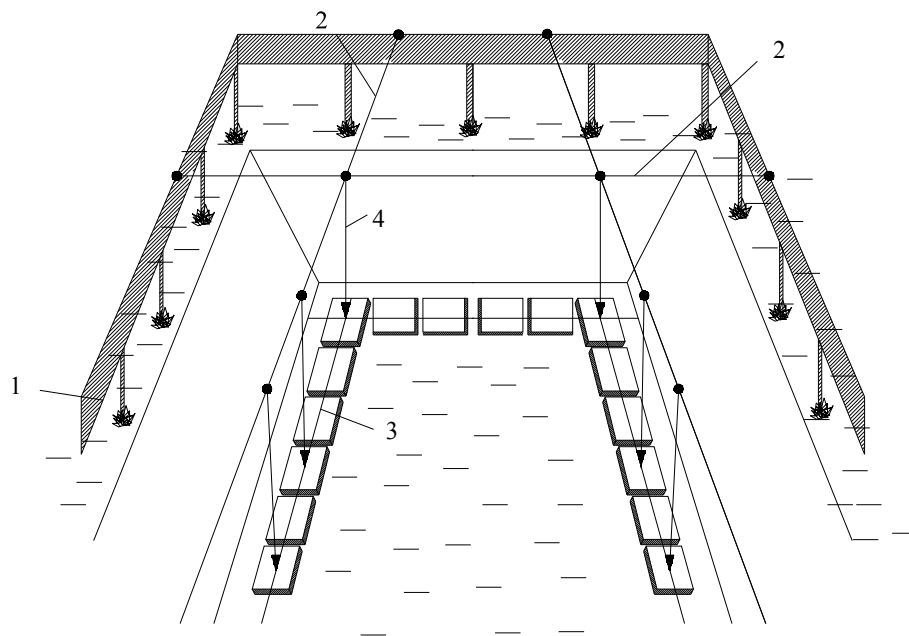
Монтаж блоков ленточного фундамента
